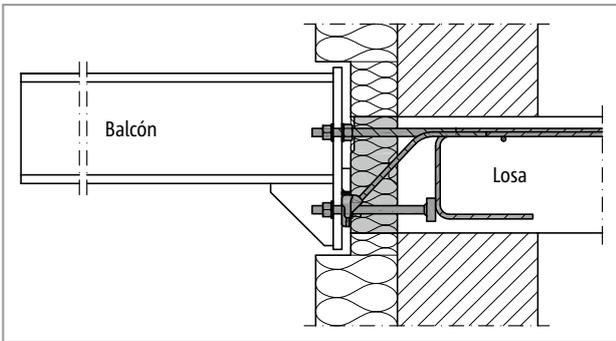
Schöck Isokorb® T tipo SK: Paso sin barreras por desplazamiento de altura
